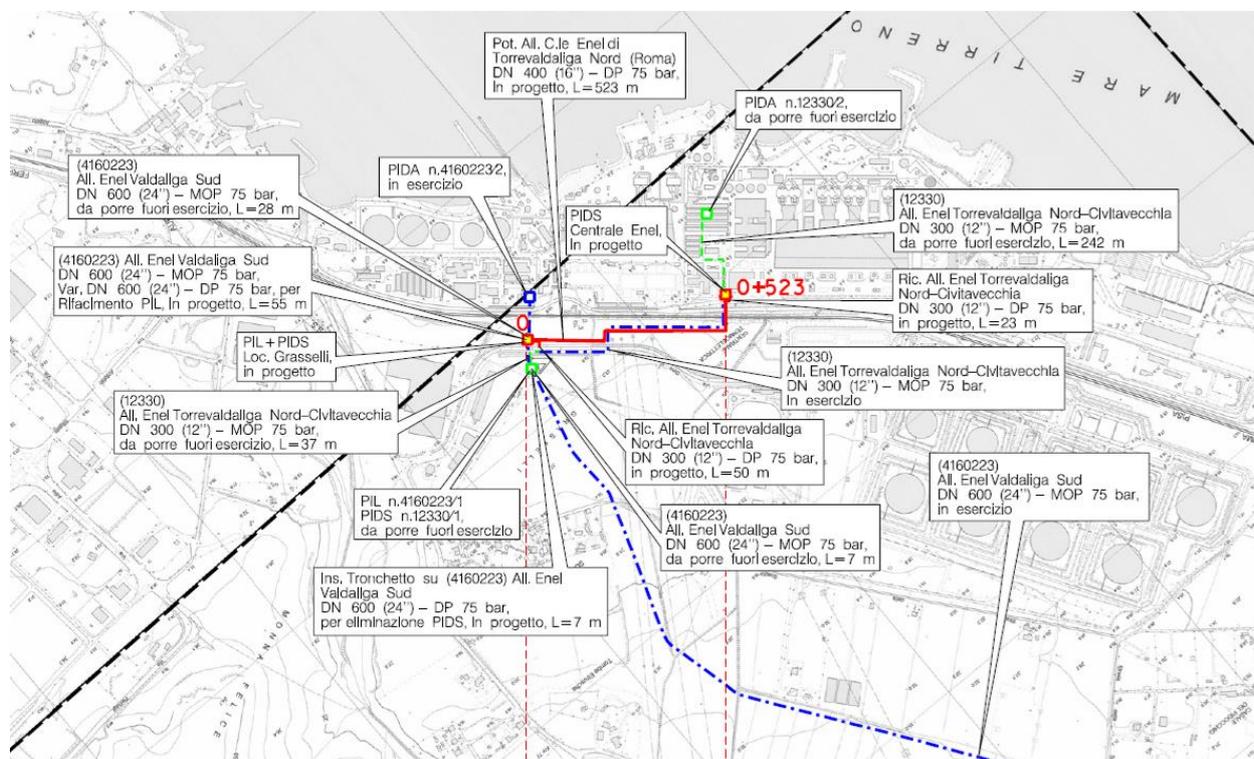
/B – Stralcio planimetrico con localizzazione del tracciato in progetto
